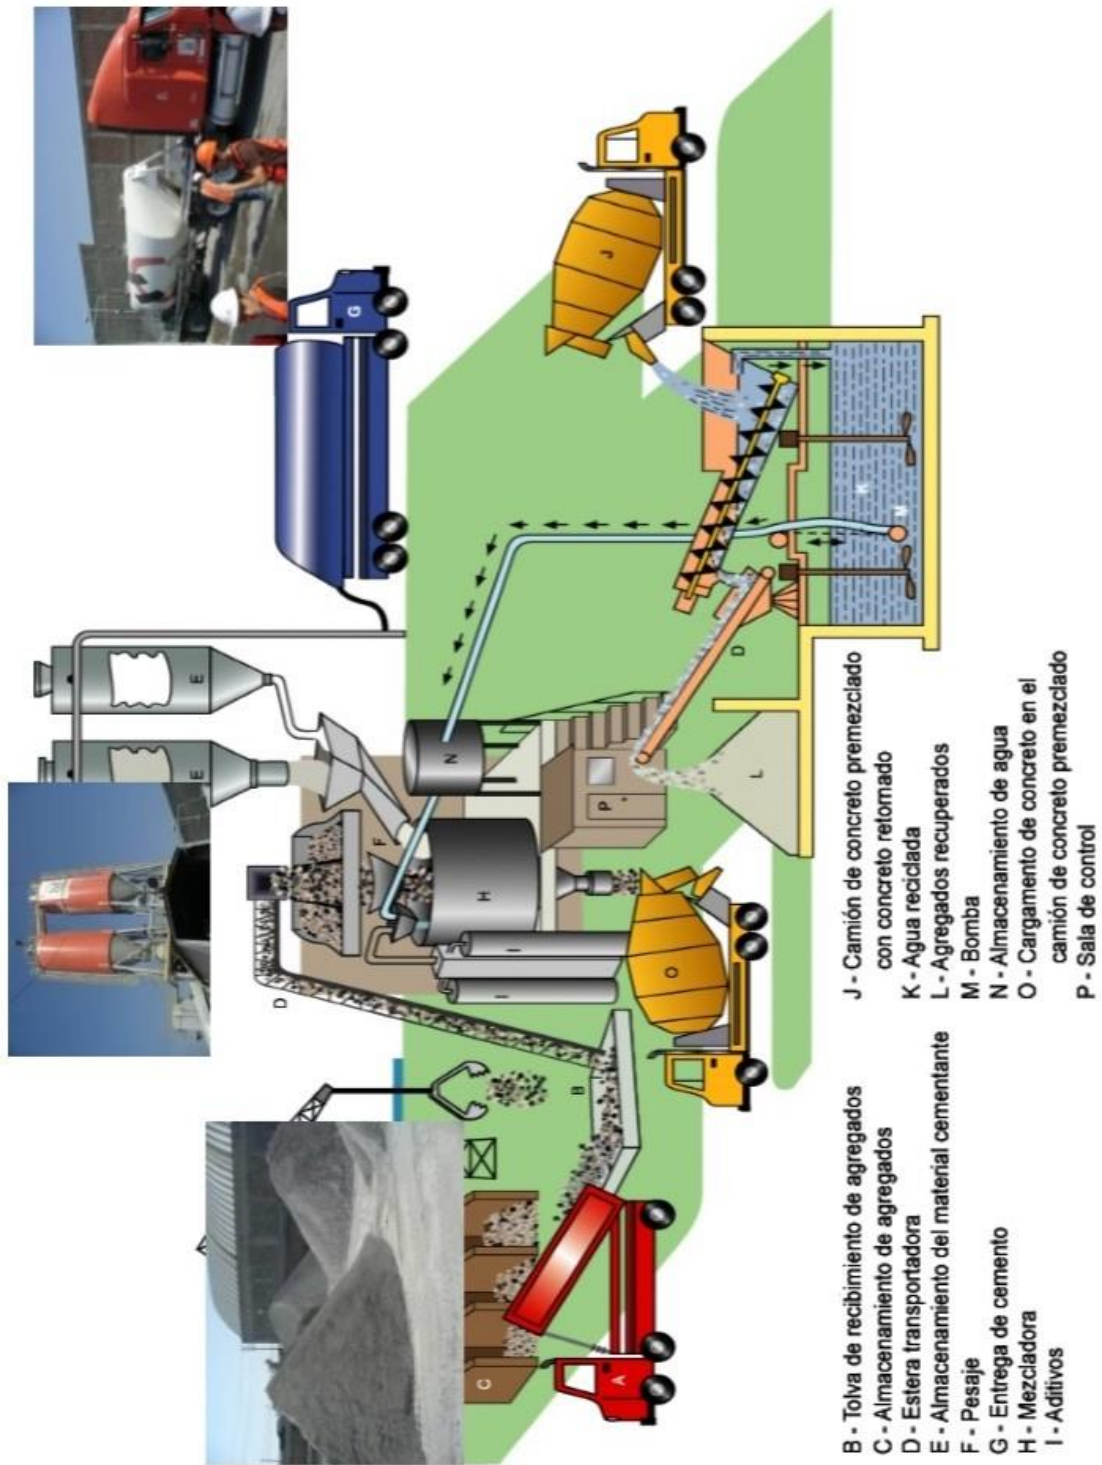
Etapas de la producción del concreto en una planta mezcladora.⁵⁵
